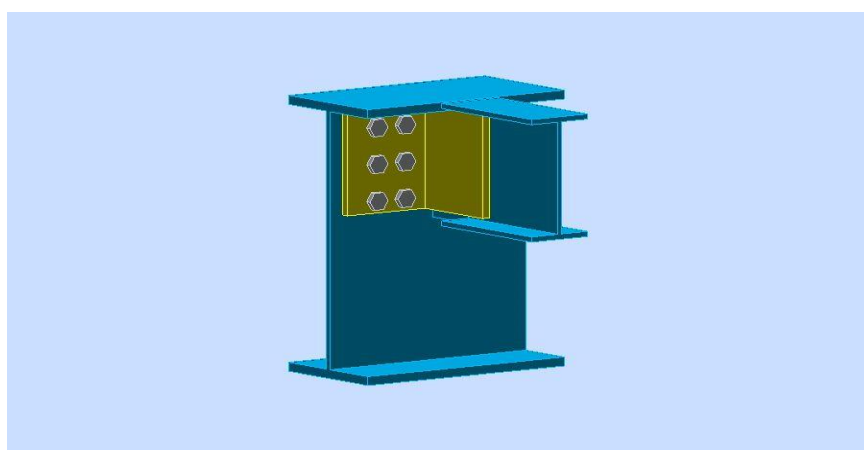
Vue 3D de l'assemblage poutre maitresse poutre secondaire.
